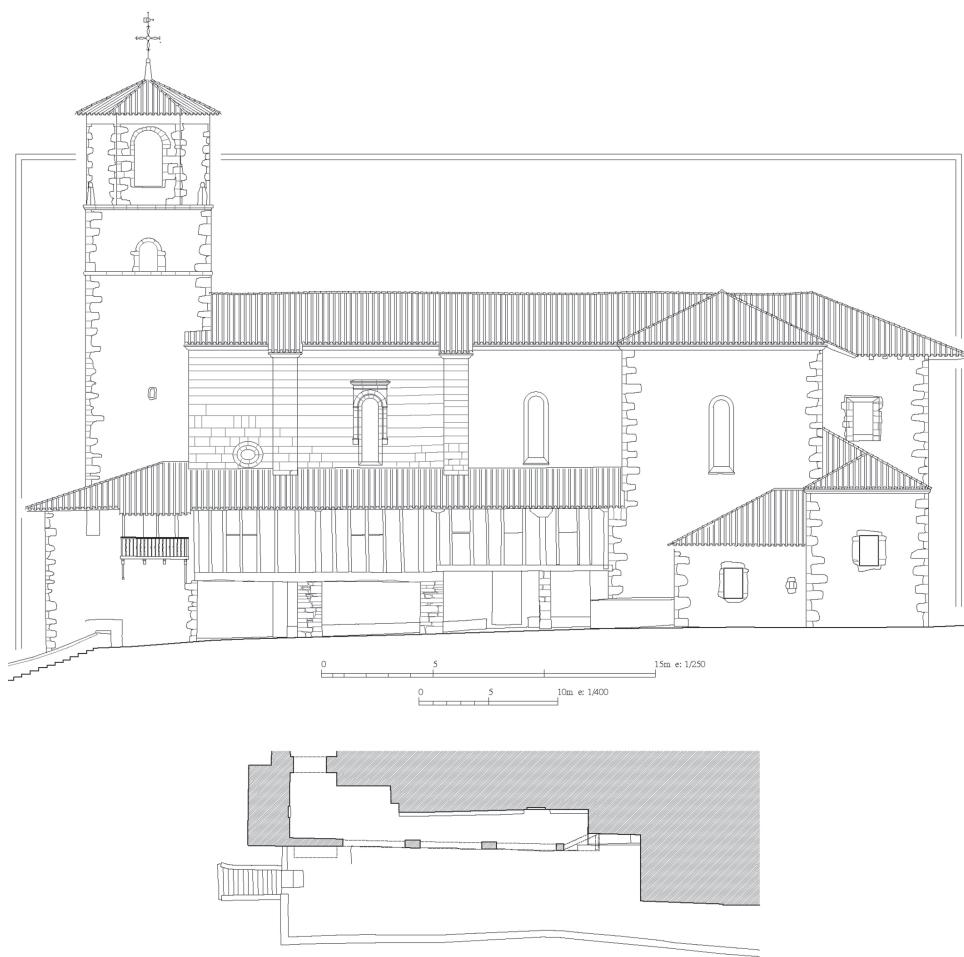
Planta y alzados de la casa Serorategia (Amaiur). / Elevation
